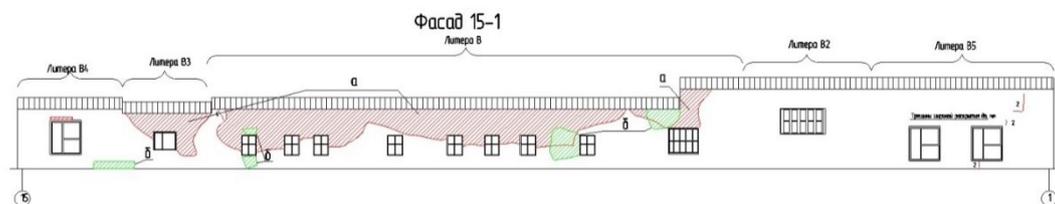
Фасад 15-1 с нанесением дефектов и повреждений, где а-разрушение кирпичной кладки в месте постоянного попадания влаги, выпадение кирпичной кладки, б – биопоражение кирпичной кладки
